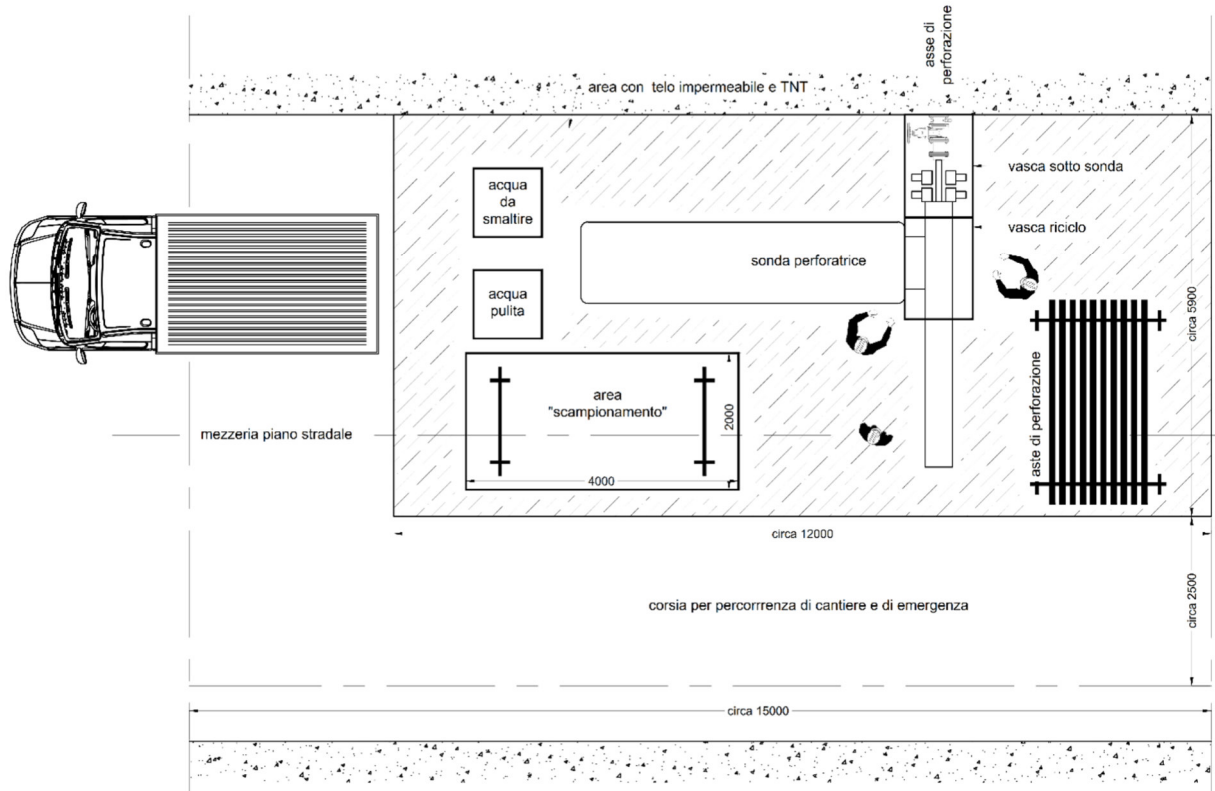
schema di cantierizzazione sonda all'interno del traforo
